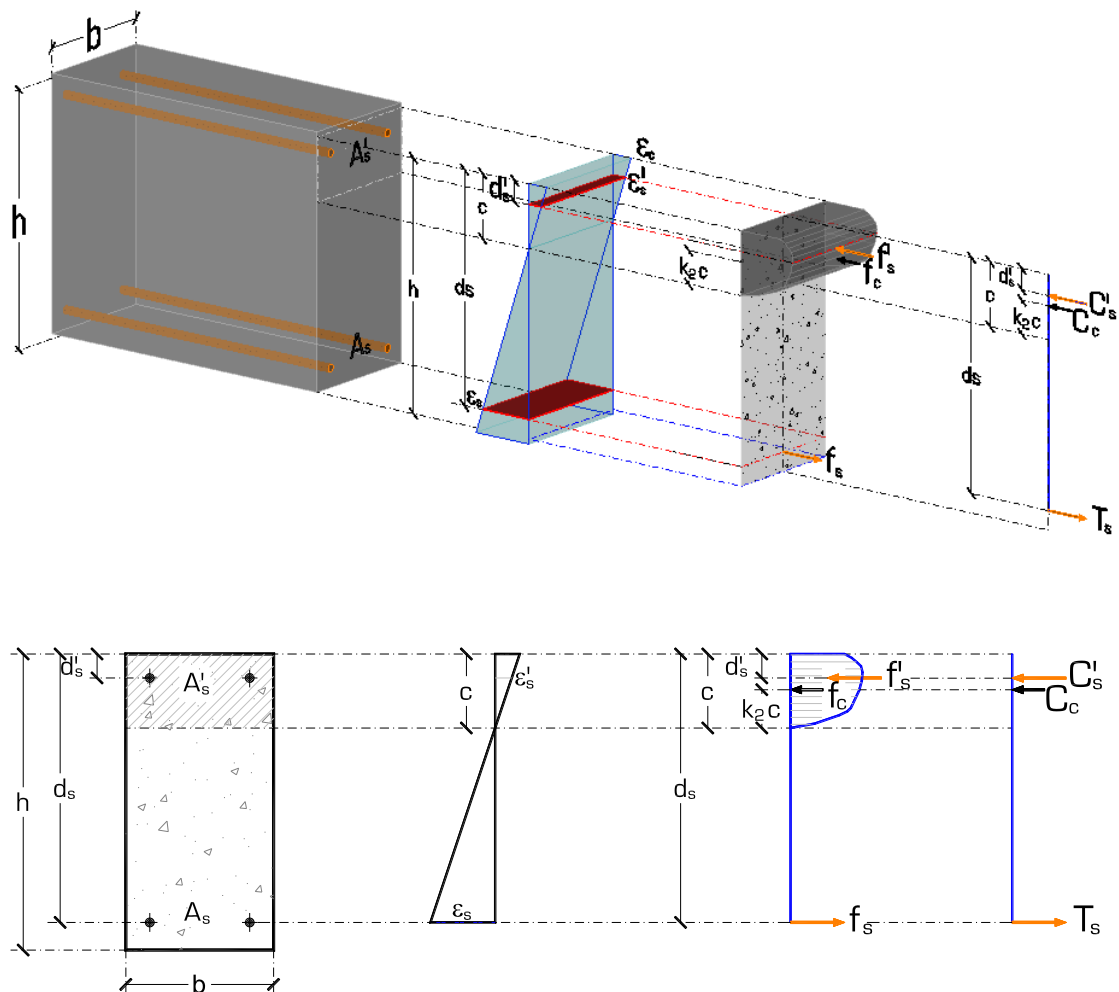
Distribución interna de deformaciones y tensiones para vigas doblemente armadas
